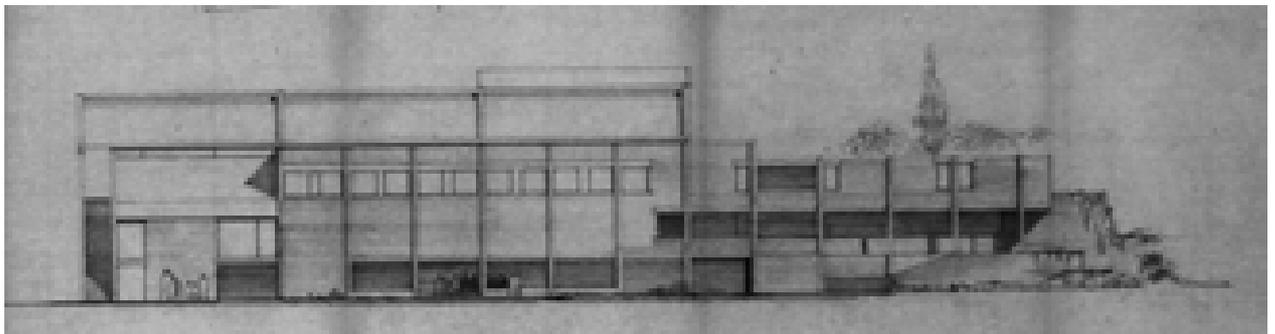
Prospetto Ovest, stato futuro– 15/01/1977 (AABS-1996.729)
